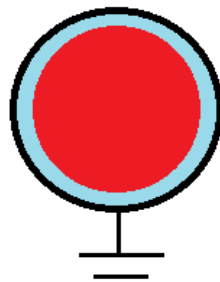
Sección de la unión entre el cable y el hilo de cobre. Fuente propia.
